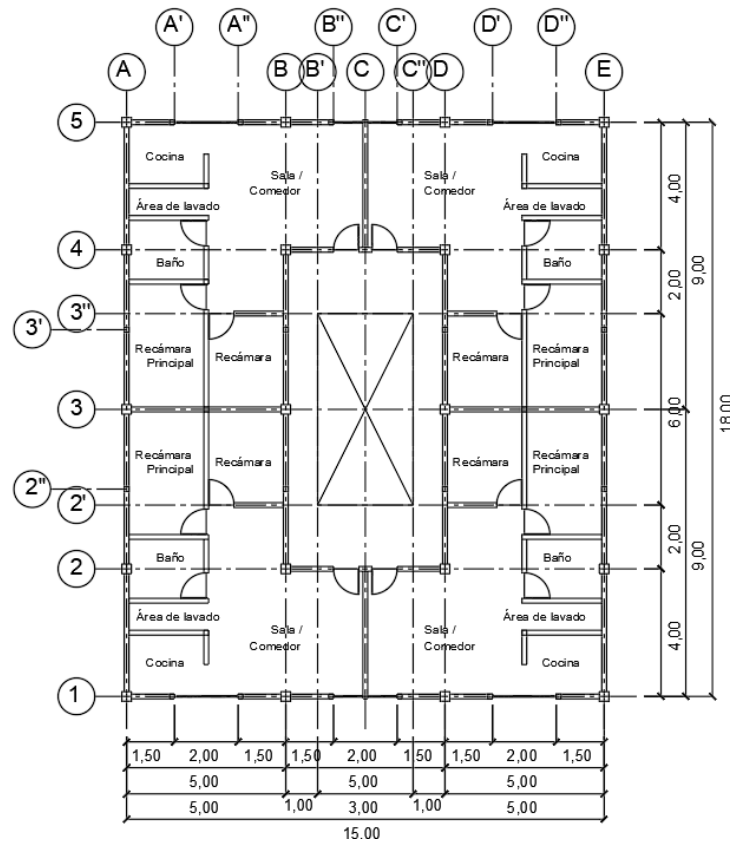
Planta de departamentos “Tipo” del modelo estructural, cotas en metros
